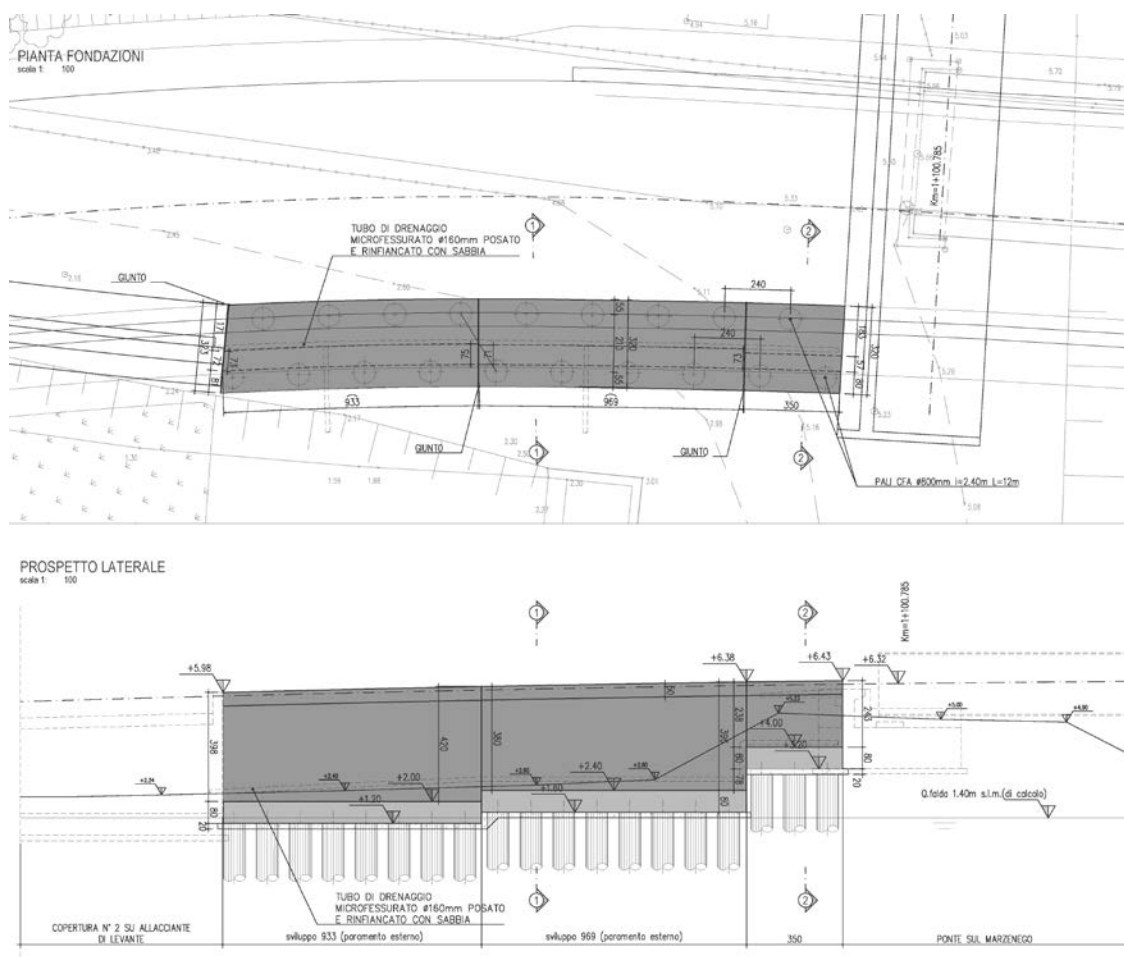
Muro di sostegno – Pianta e Prospetto
